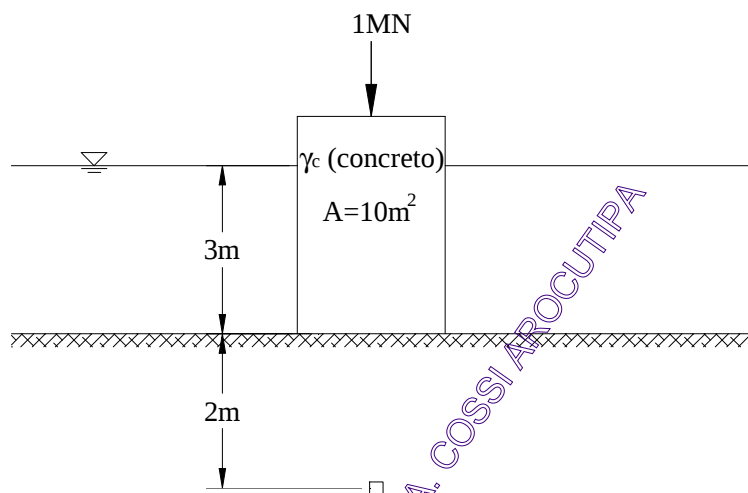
Estribo de un puente con un nivel freático por encima del terreno.
